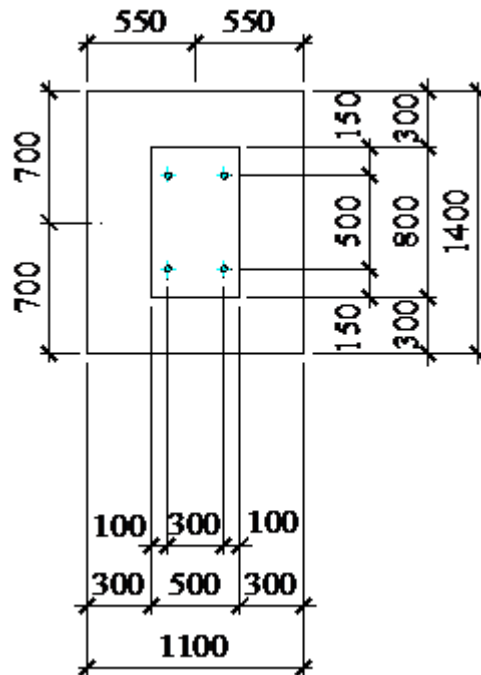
Розрахункова схема до розрахунку фундаменту
